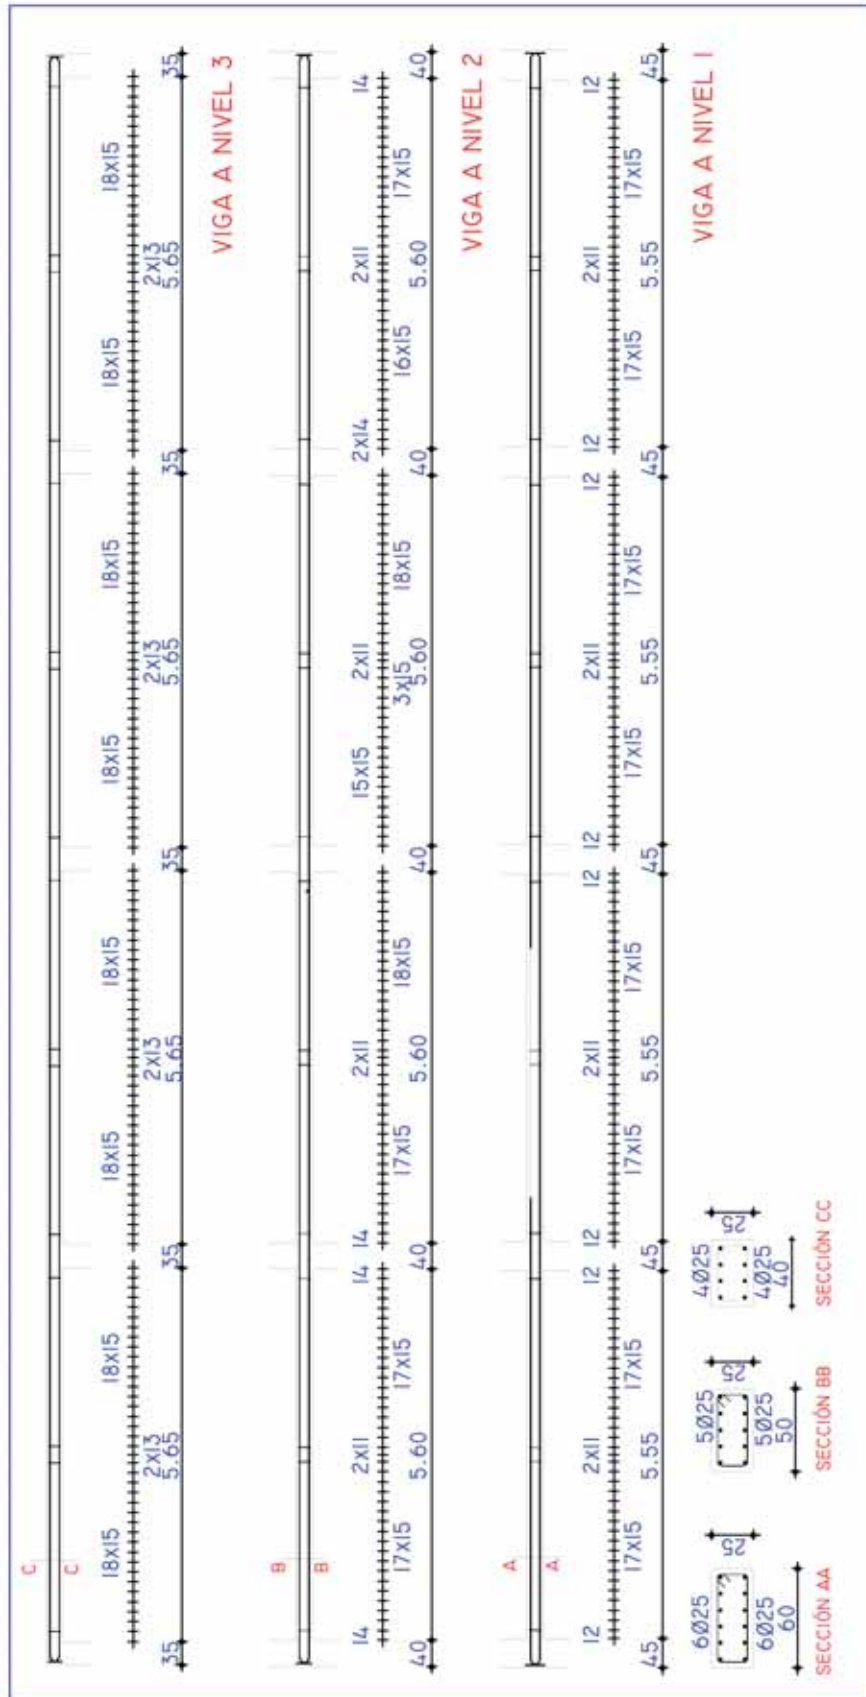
Detalles de armado de las vigas del pórtico exterior.
